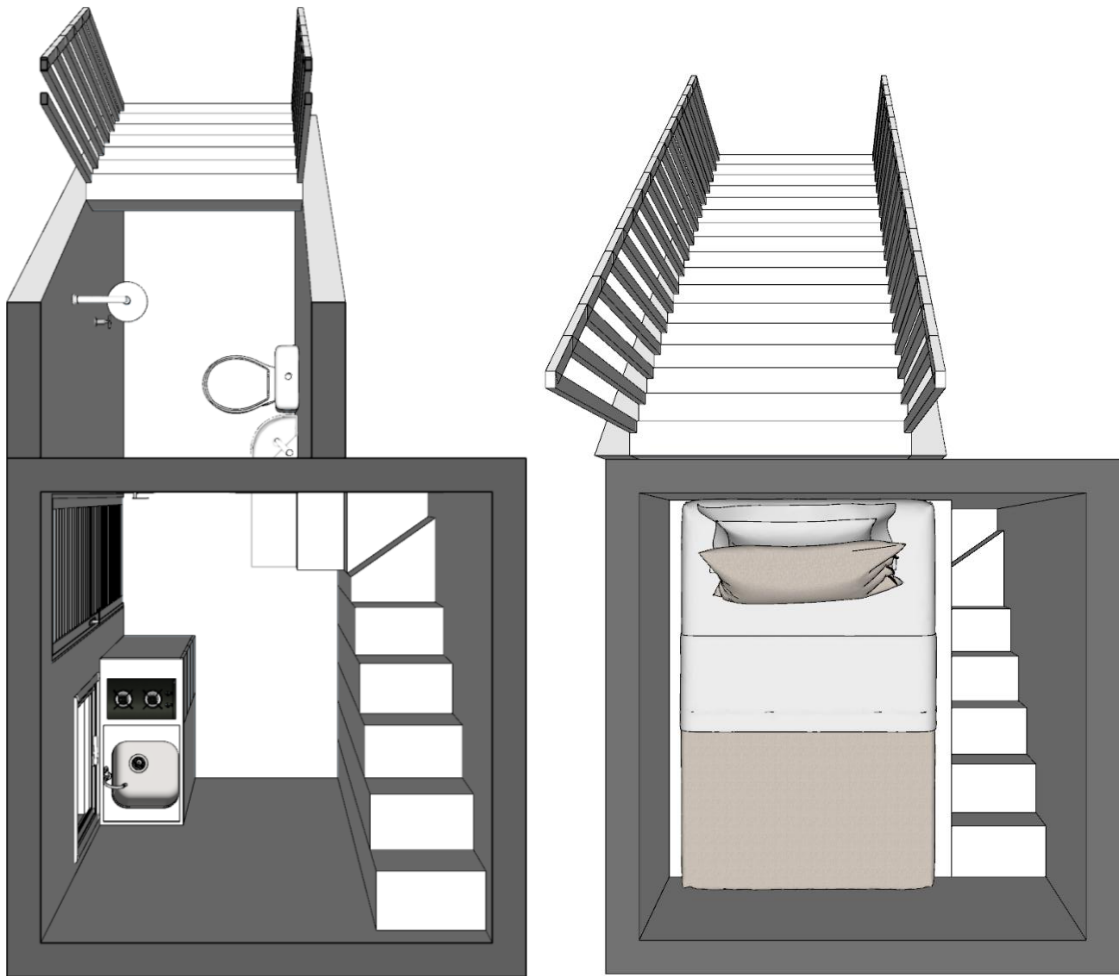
Vista interna do projeto original para a casa do Francisco.
